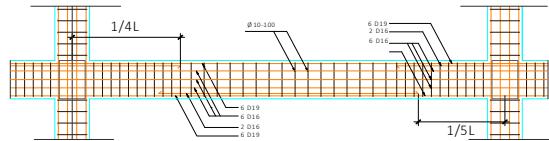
Detail tulangan lantai 2 (balok type 2)
